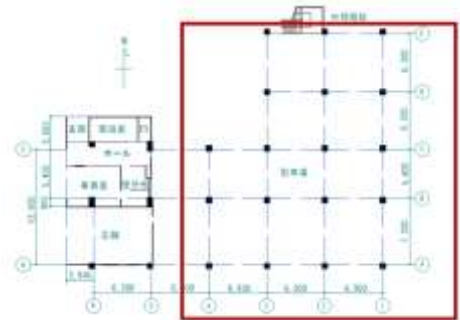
対象構造物①の 1 階平面図 (S=1/200)
